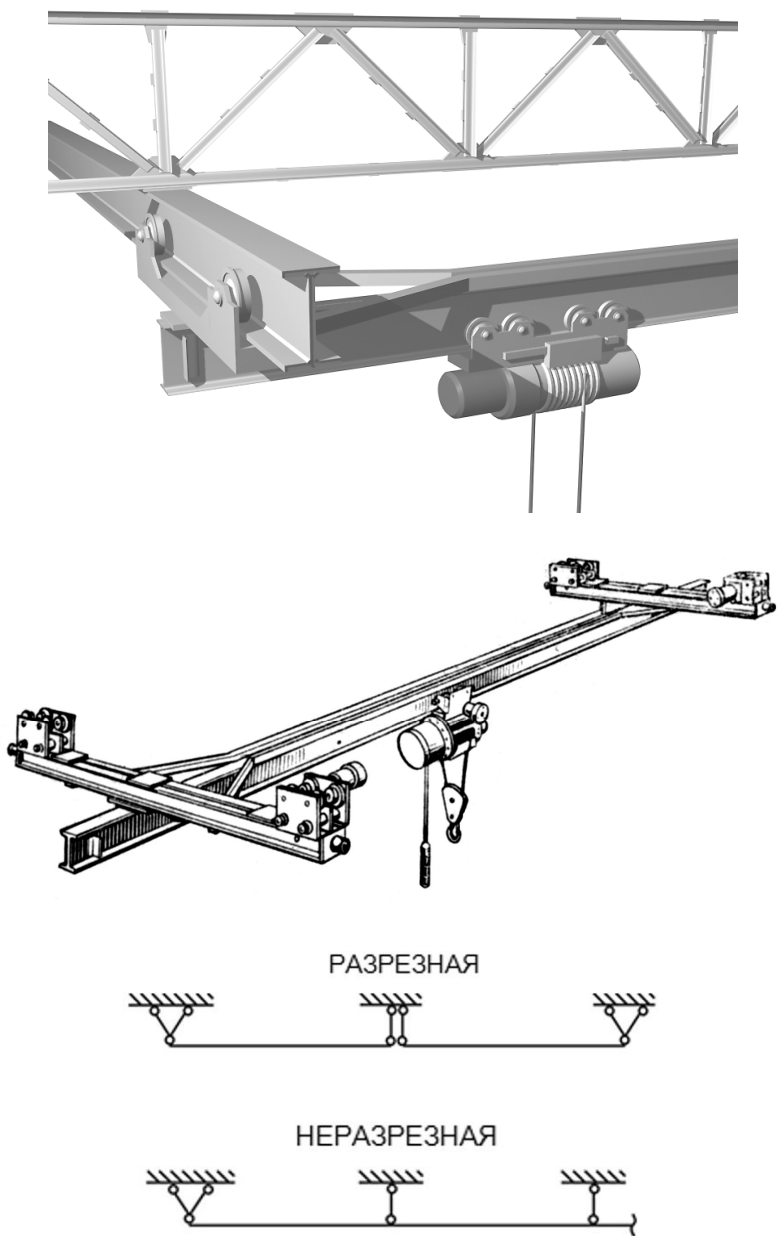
Двухопорный подвесной кран (кран-балка). Расчетные схемы подкрановых конструкций
